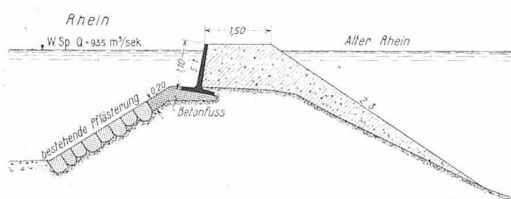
Normalprofil der Uferverbauung mit Betonplatten. Masstab 1 : 150.
